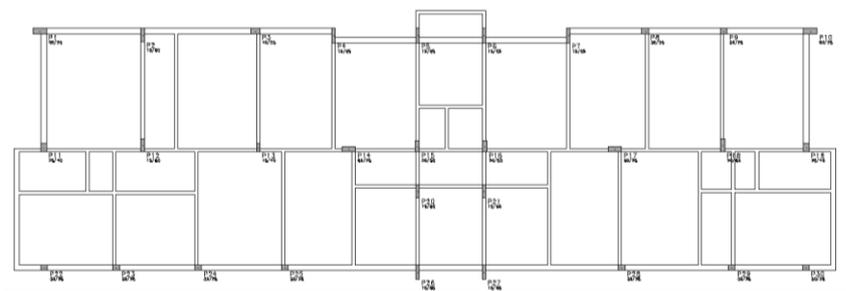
Planta de fôrmas do pavimento tipo - Modelagem ORIG- 8PAV/PILAR
